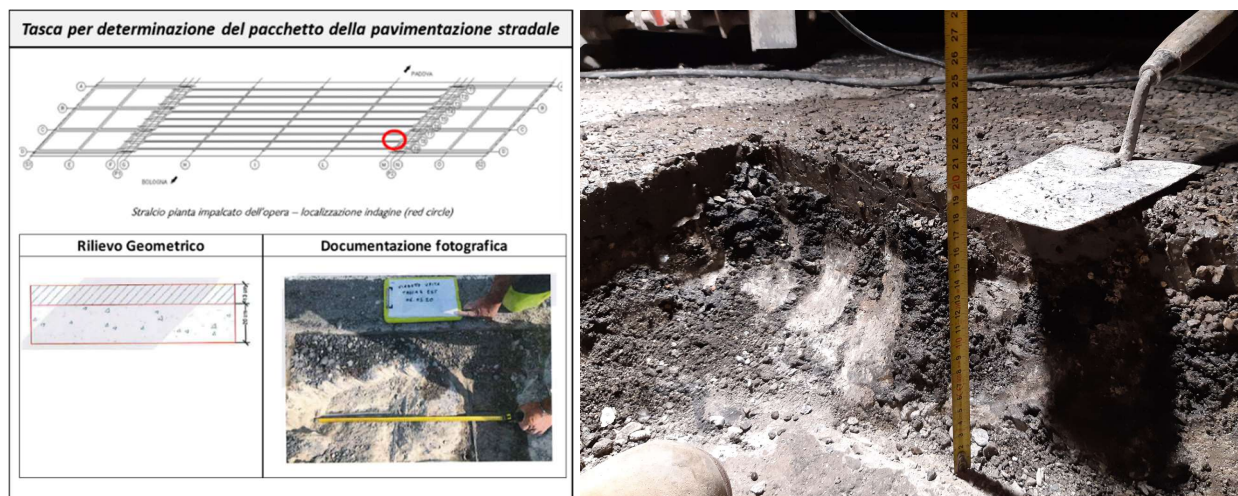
Esempio di restituzione- Determinazione spessore pavimentazione stradale (saggio diretto e fori)
